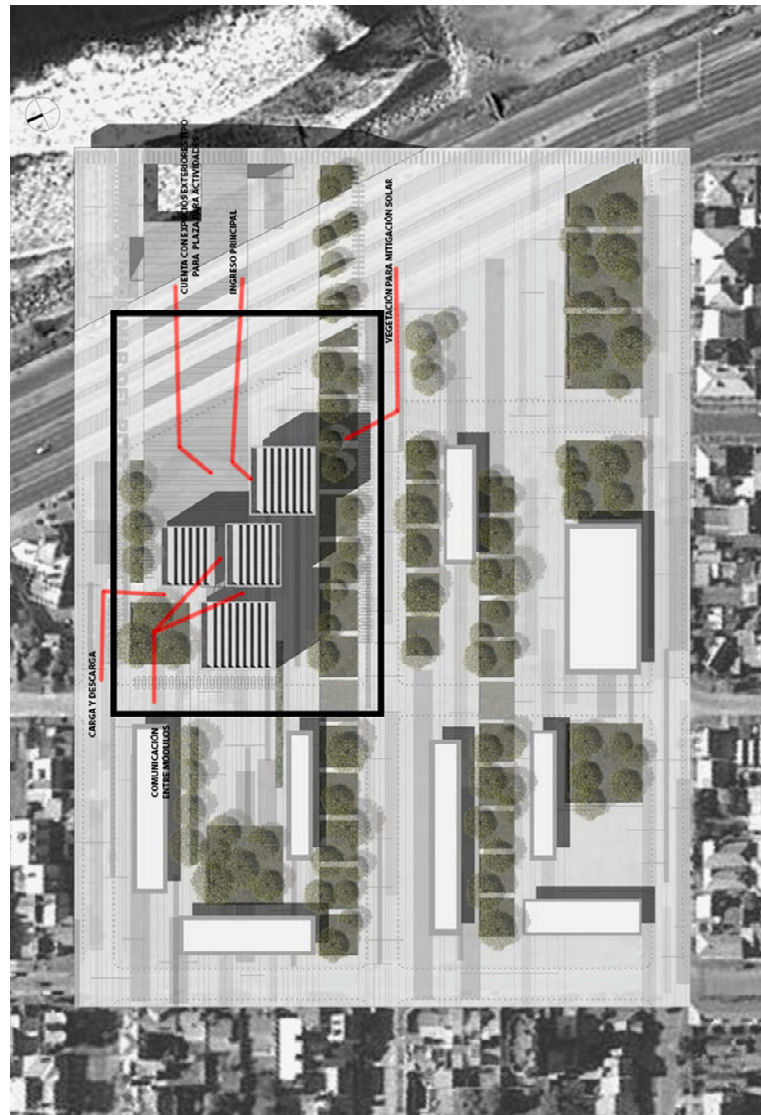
Planta Conjunto Museo de Arte Contemporáneo.
